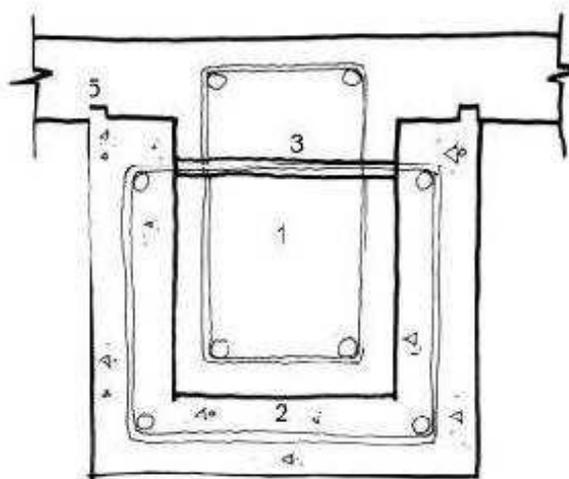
Imagen de vista en corte de ubicación de refuerzos adicionales. Fuente: (Sarmientos, 2003)
